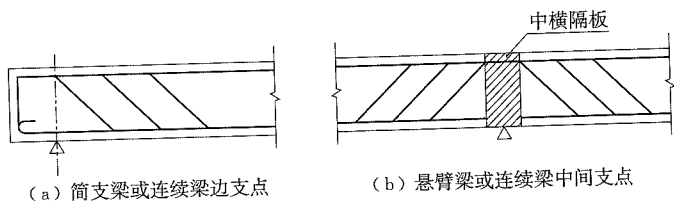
弯起钢筋弯起点位置示意图(二)
